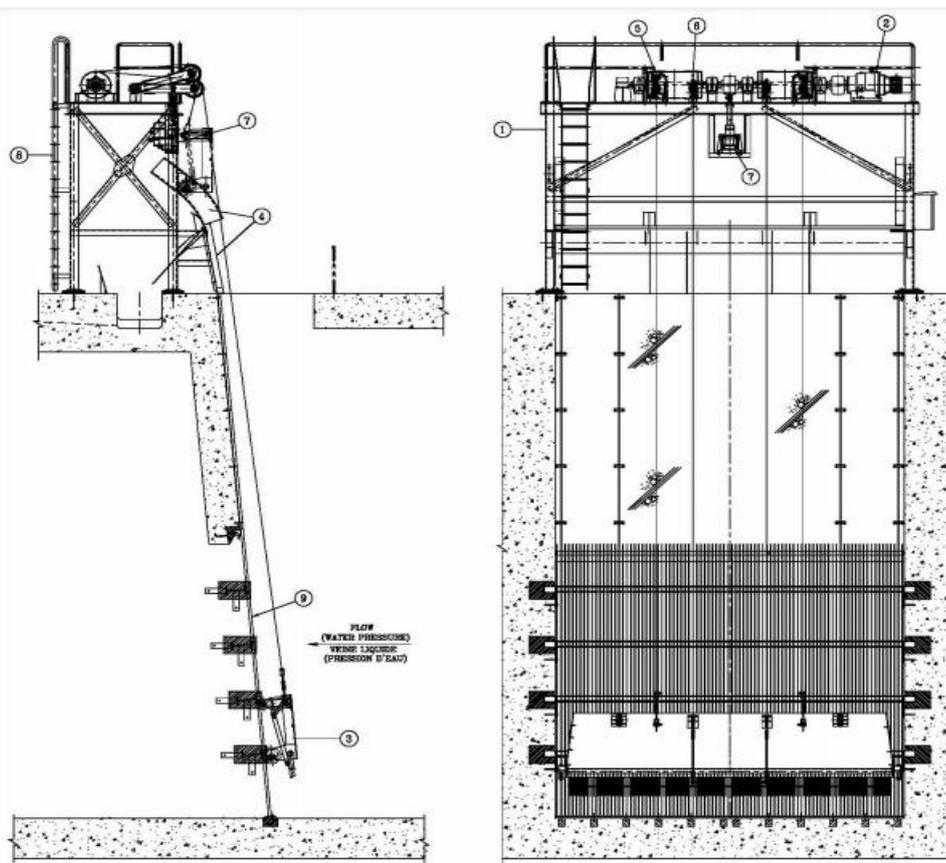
Dispositif général de grille à barreaux avec la machine de grille à débris
